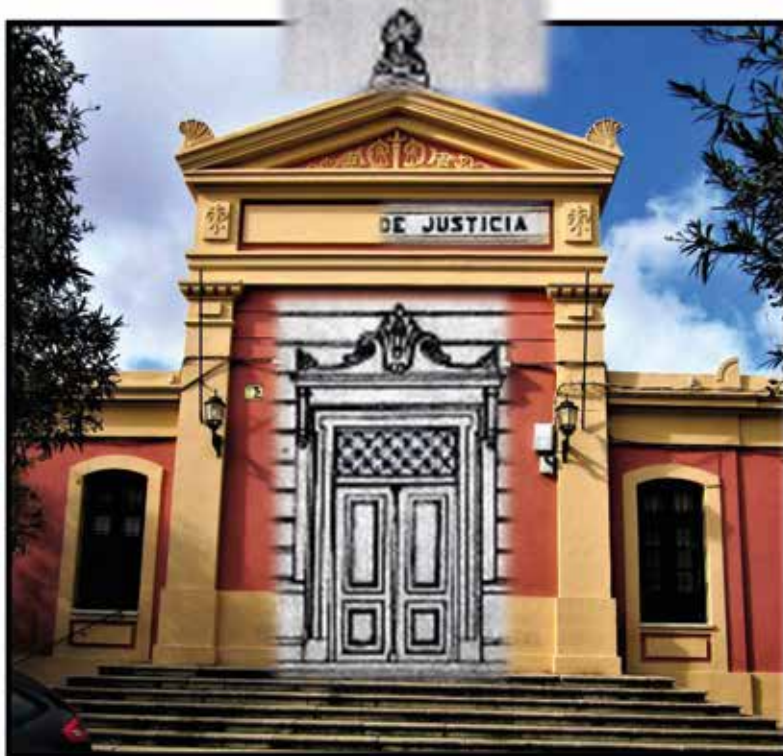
a 474. Plano proyectado para el levantamiento del Palacio de Justicia en Alameda de Guadalupe, y fachada principal en la actualidad. Existen fotografías retrospectivas del edificio, donde pueden observarse en el frontal las palabras: "Palacio de Justicia", tal como se reflejan en el plano, después del traslado de los juzgados, las palabras fueron suprimidas para evitar confusión. Fuente: Legajo 111 / AMA. Imagen de la autora.
